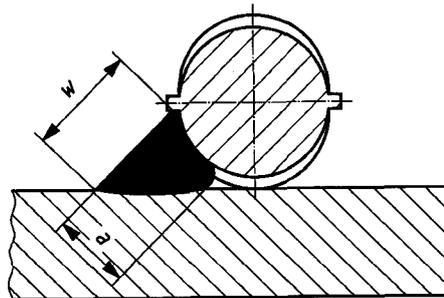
Flankenkehlnähte am gebogenen Betonstahlstab
